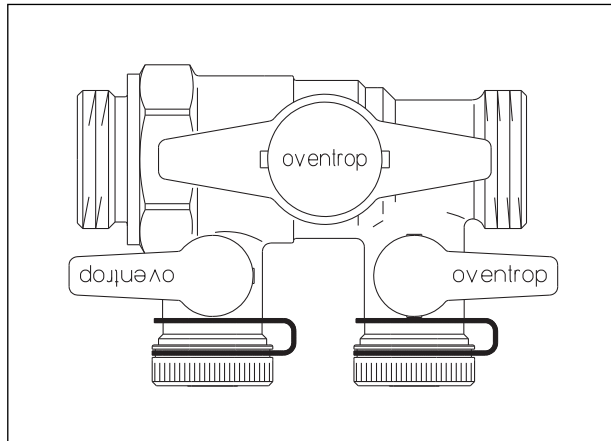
Ensemble de remplissage et de rinçage, réf. OV 136 30 51
